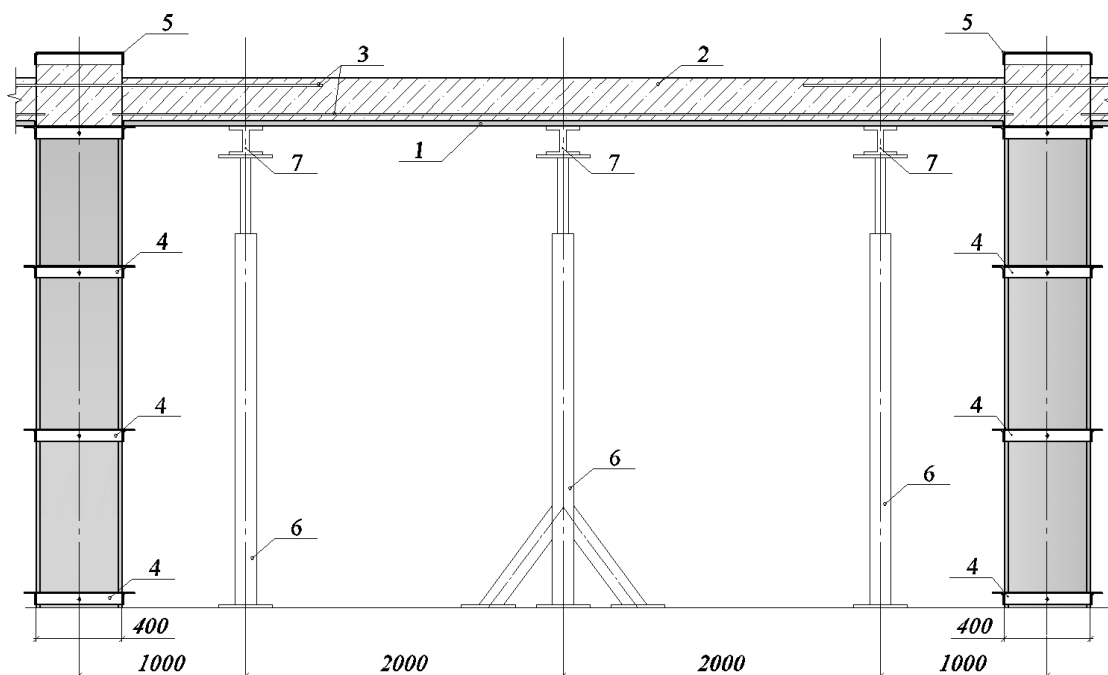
Схема монтажа здания с несущими колоннами и безбалочным перекрытием:
